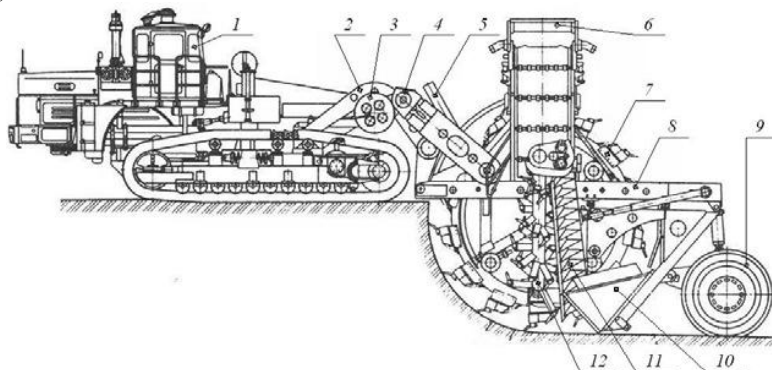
Шнекороторный экскаватор-каналокопатель ЭТР-208: 1 – тягач; 2 – поворотная рама; 3 – редуктор привода ротора; 4 – цепная передача; 5 – гидроцилиндры подъема рабочего органа; 6 – конвейеры; 7 – ковшовый ротор; 8 – рама рабочего органа; 9 – колесная опора; 10 – зачистное устройство; 11 – боковые зачистные устройства; 12 – шнеки
